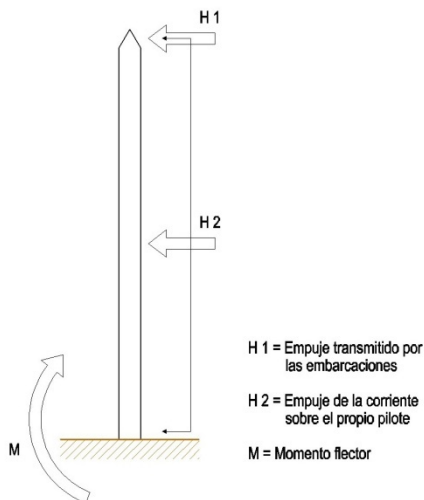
Momento flector sobre el pilote en la sección de empotramiento
